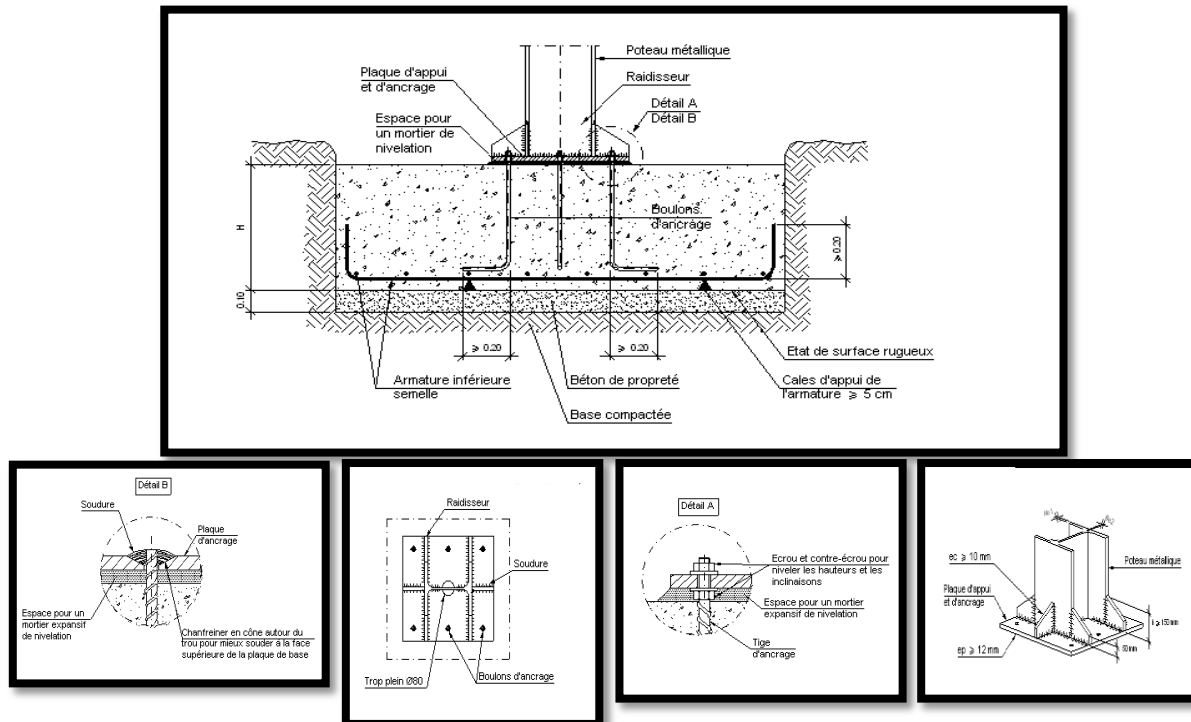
Détail encrage poteaux fondation source <http://detailsconstructifs.cype.fr/EAC803.html>
